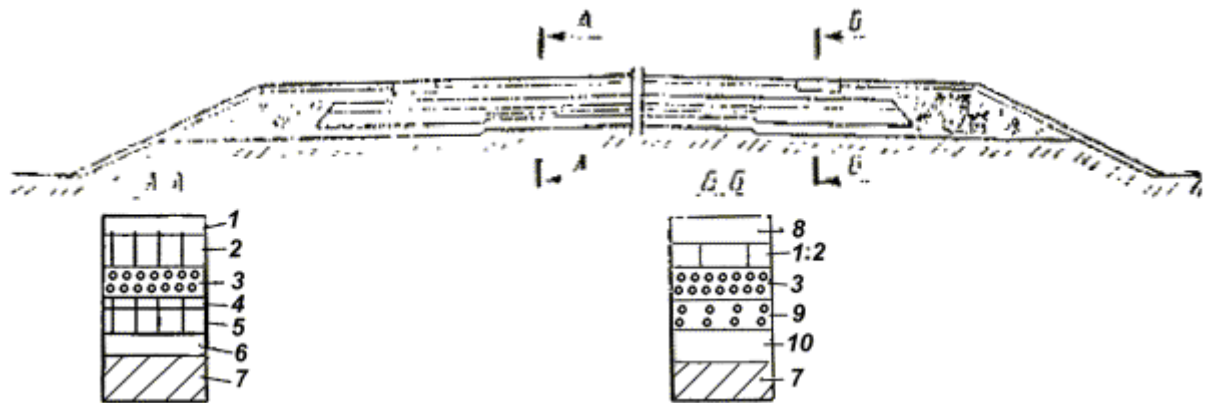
Конструкции с теплоизоляционным слоем на реконструируемых дорогах, расположенных на пучинистых участках:
